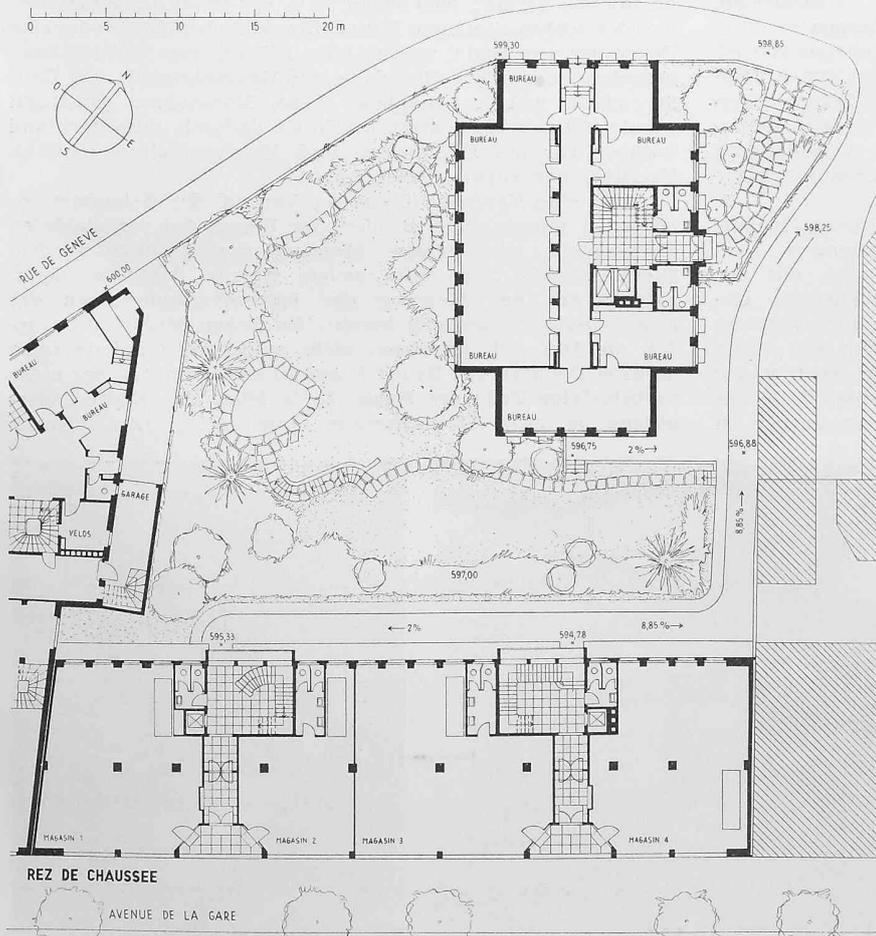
, Erdgeschoss-Grundriss beider Neubauten, 1:500
